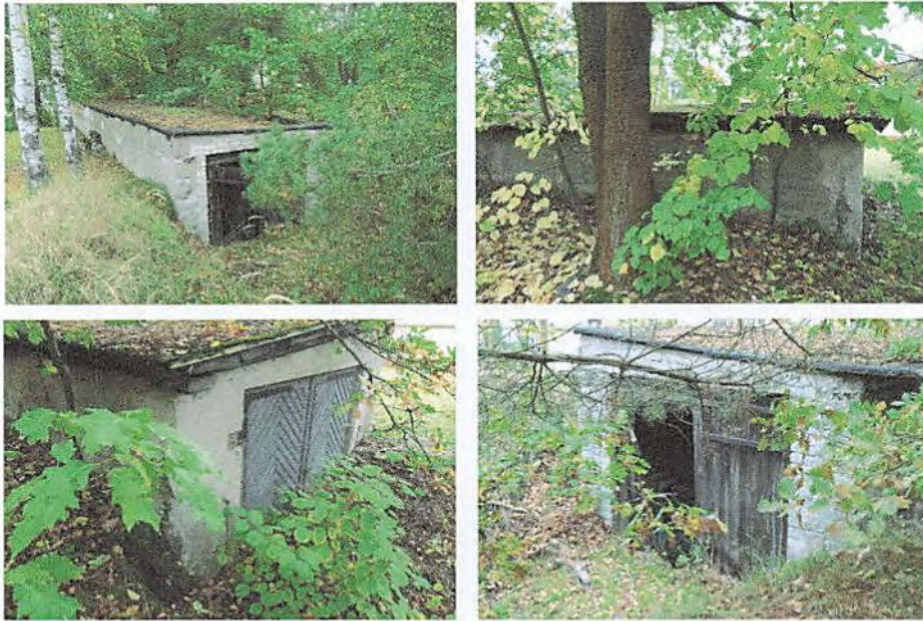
Eine ruinöse Doppelgarage im nordwestlichen Grundstücksbereich; verwilderte Außenanlagen
